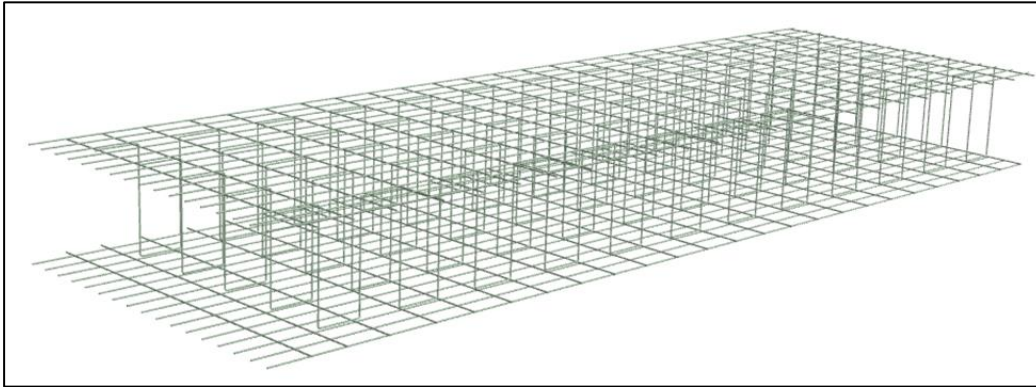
3D-Bewehrungsstruktur für ein modulares Deckenelement
